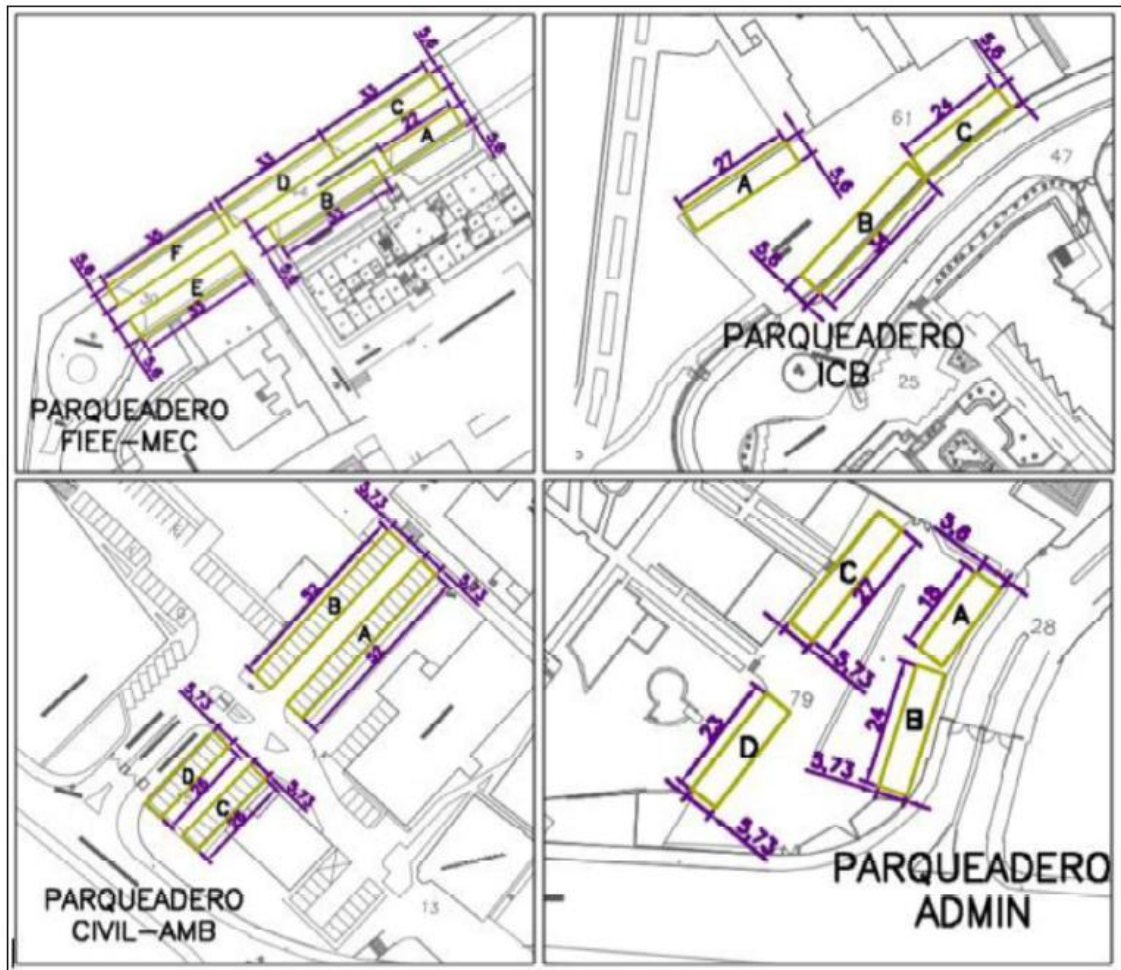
Ubicación en el plano de las posibles zonas para el emplazamiento del sistema de generación fotovoltaico Fuente: (Quishpe 2020).
